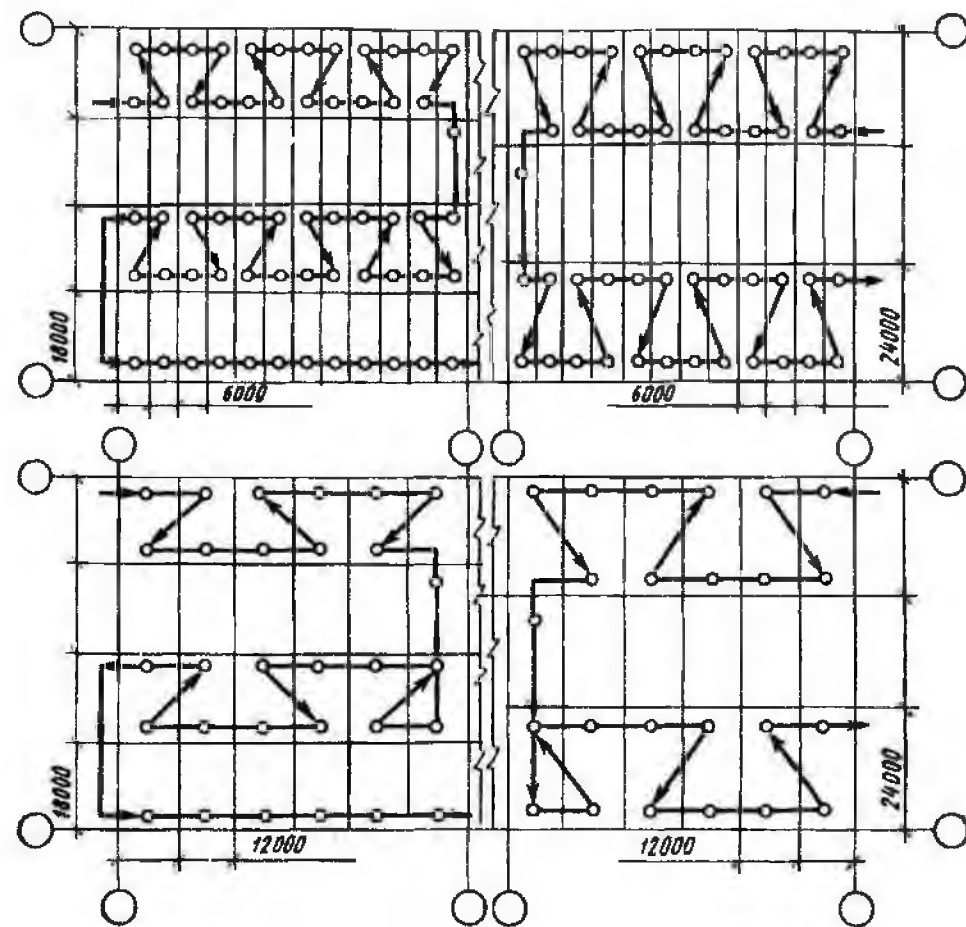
Схема движения крана при установке подкрановых балок проле-
